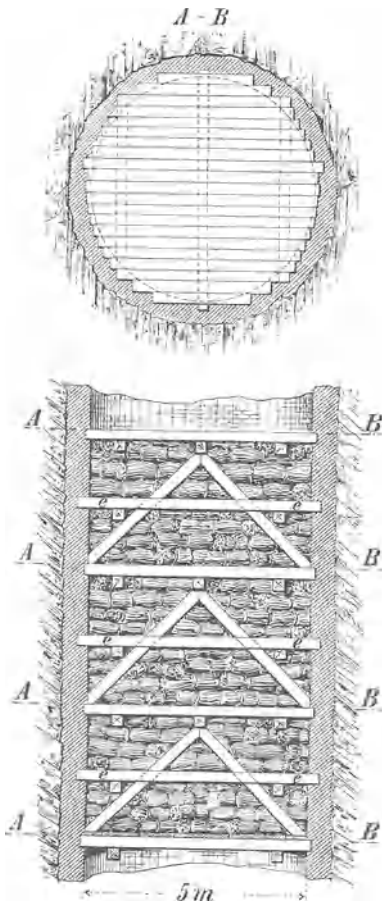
Sicherheitsbühne aus Holz mit Faschinenpackungen.
